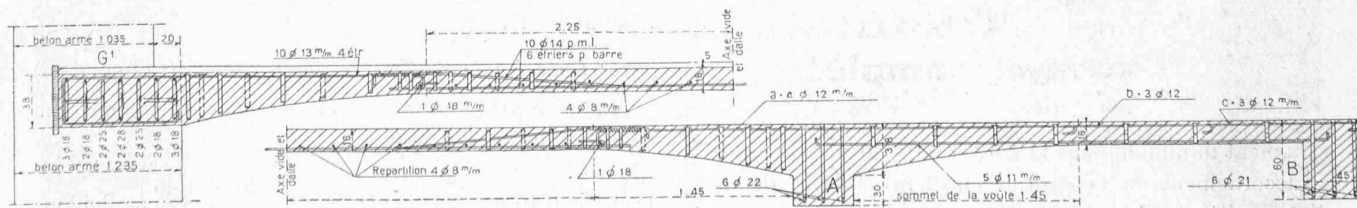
Armatures de la poutraison sur le rez-de-chaussée. — Demi-coupe C-D.
